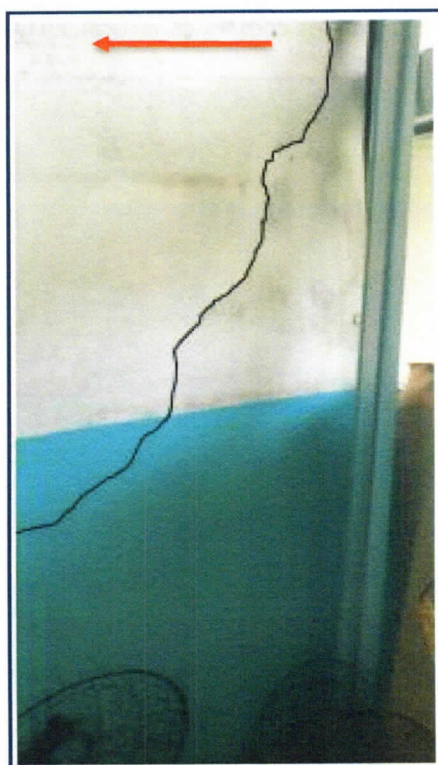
Vista da parede de alvenaria, à esquerda da porta, com fissura vertical.
